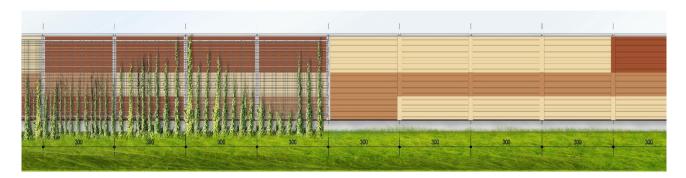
BARRIERA ACUSTICA OPACA FONOASSORBENTE SU RILEVATO – VISTA PROSPETTICA LATO RICETTORE
